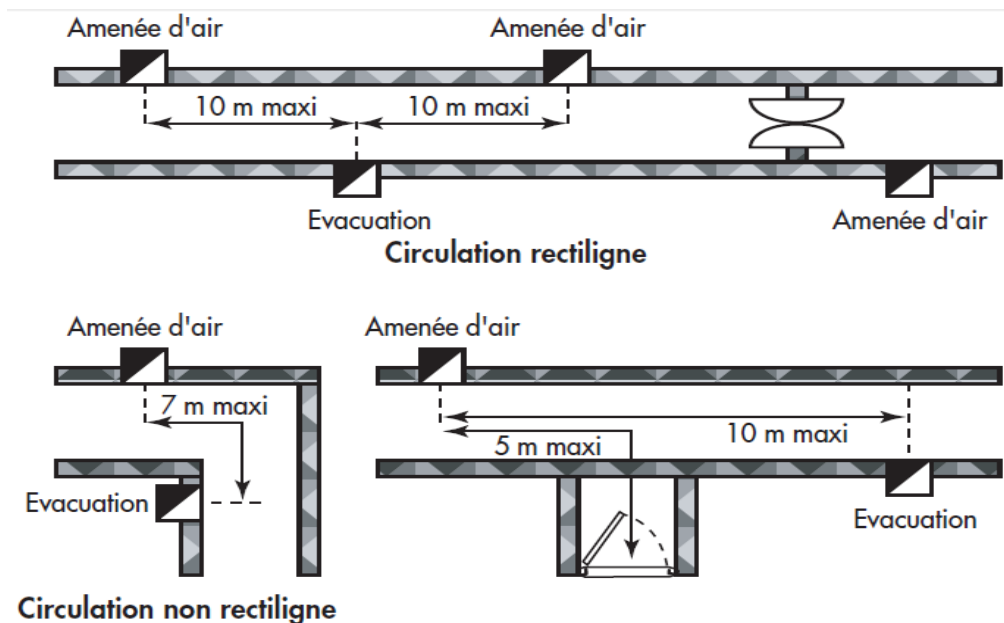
Exemples d'implantation des bouches de désenfumage [1].
